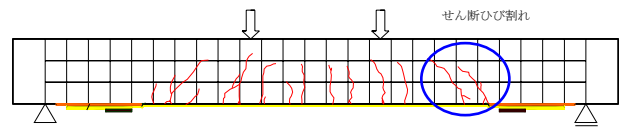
ひび割れ状況 (case1-3 静的載荷後)
